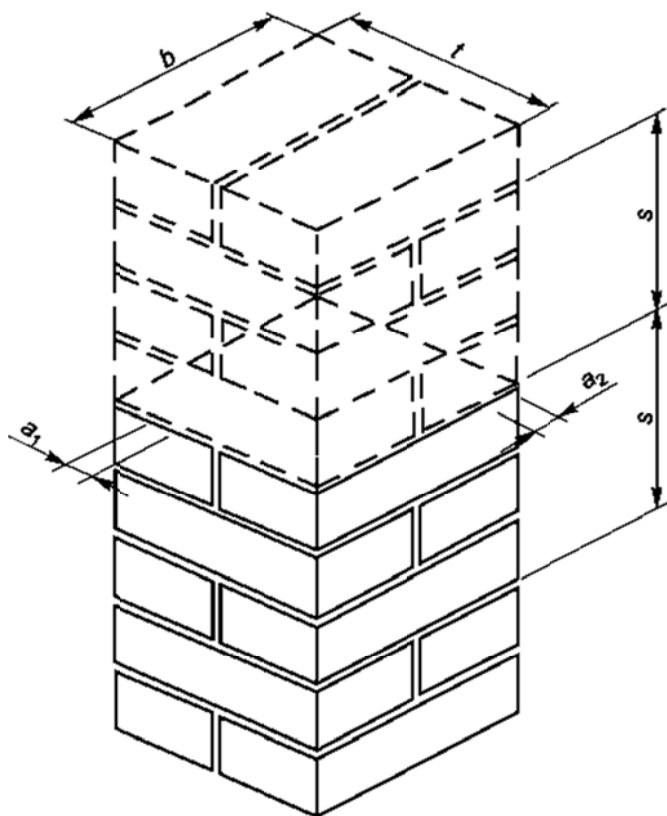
Армирование столбов и простенков сетками в горизонтальных швах кладки
